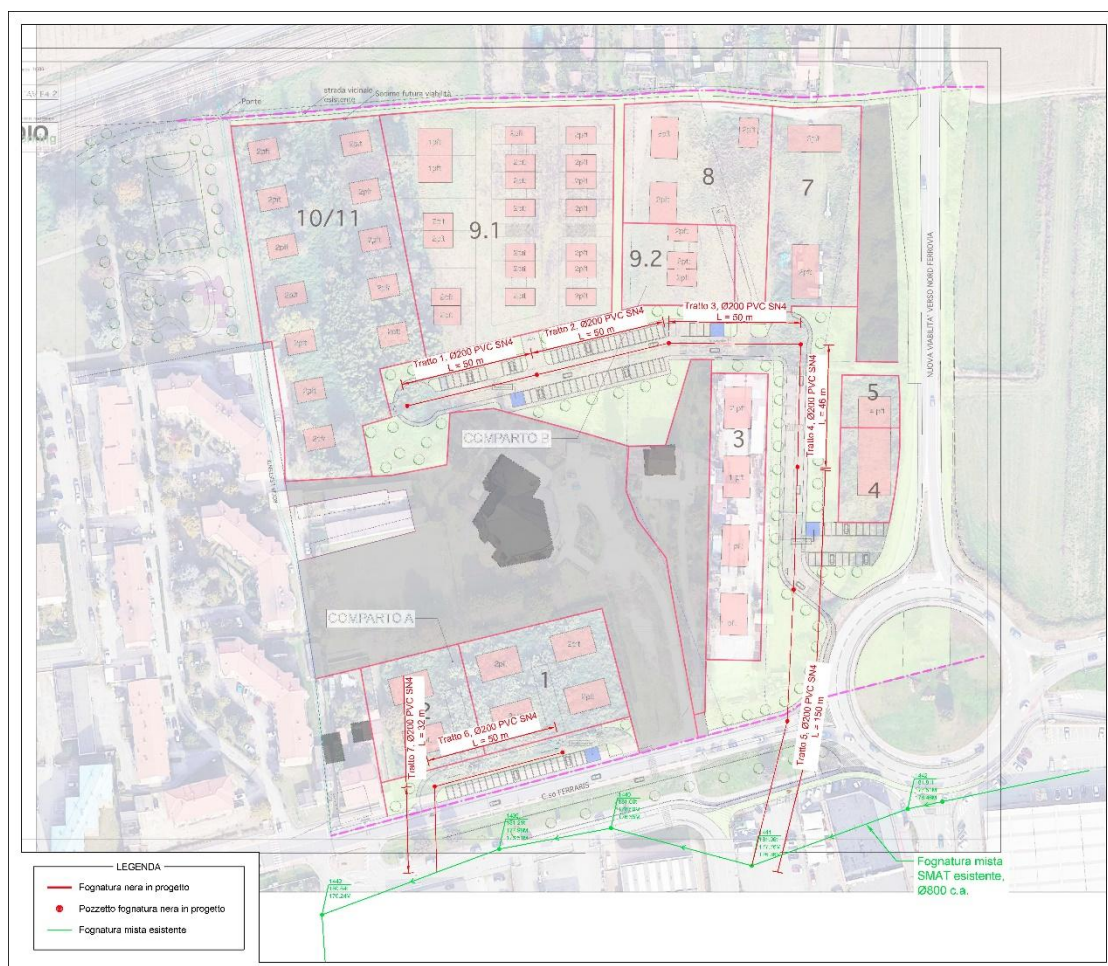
Planimetria di inquadramento dei tratti di rete fognaria in progetto.
